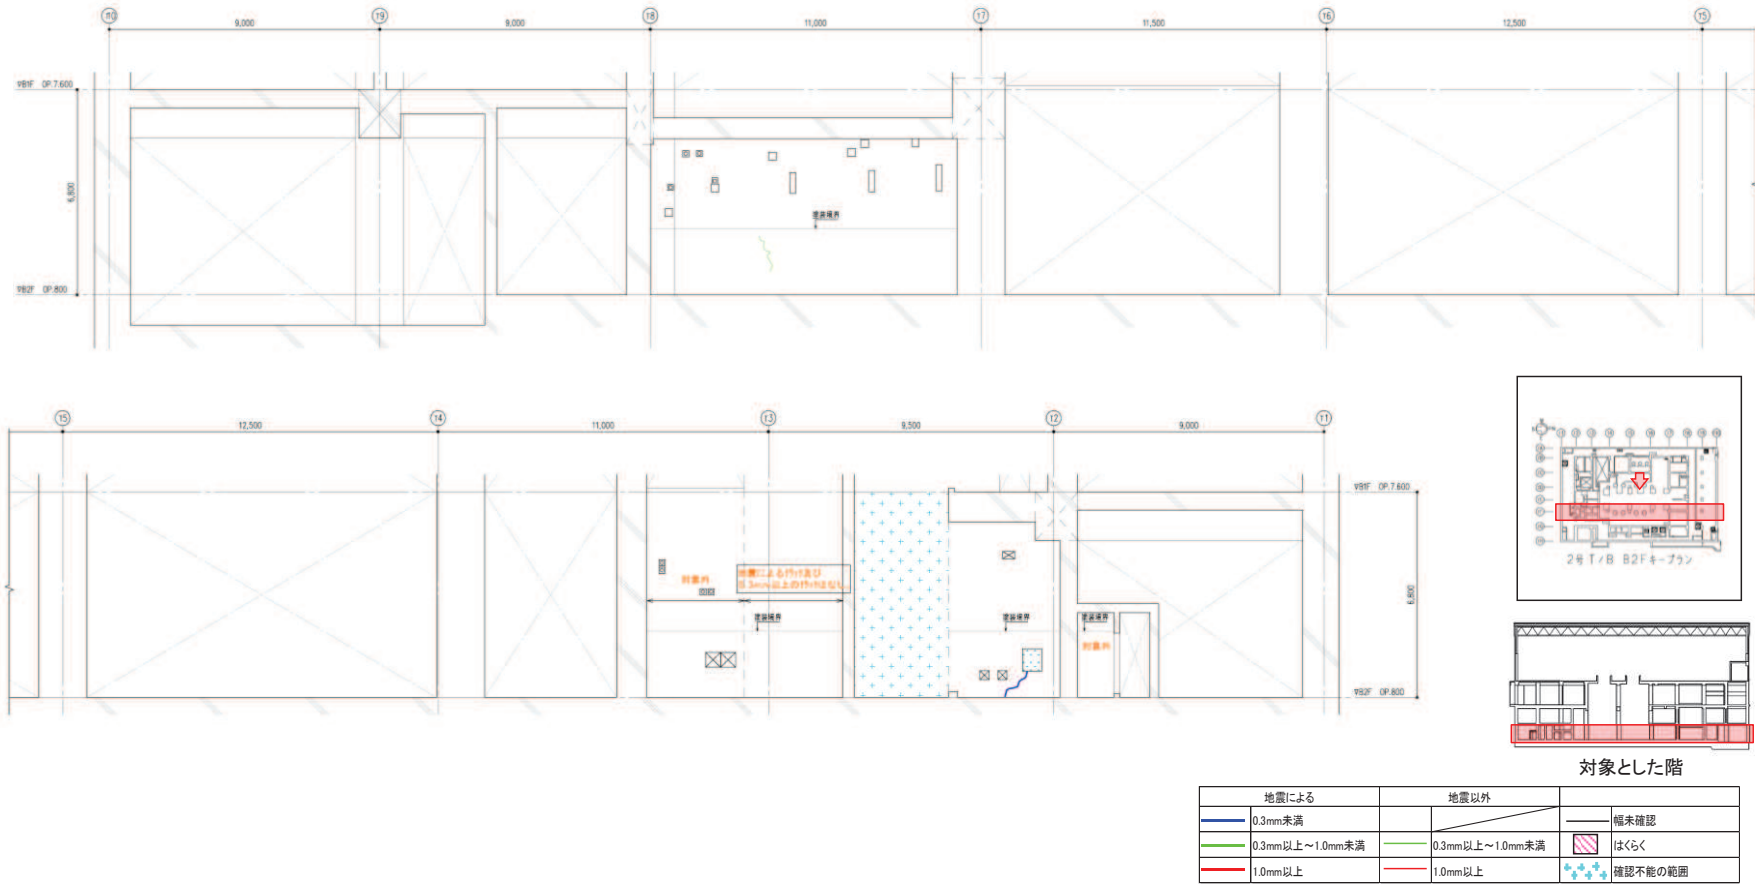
タービン建屋のひび割れ分布 耐震壁 (14) 地下 2 階 TF 通り
